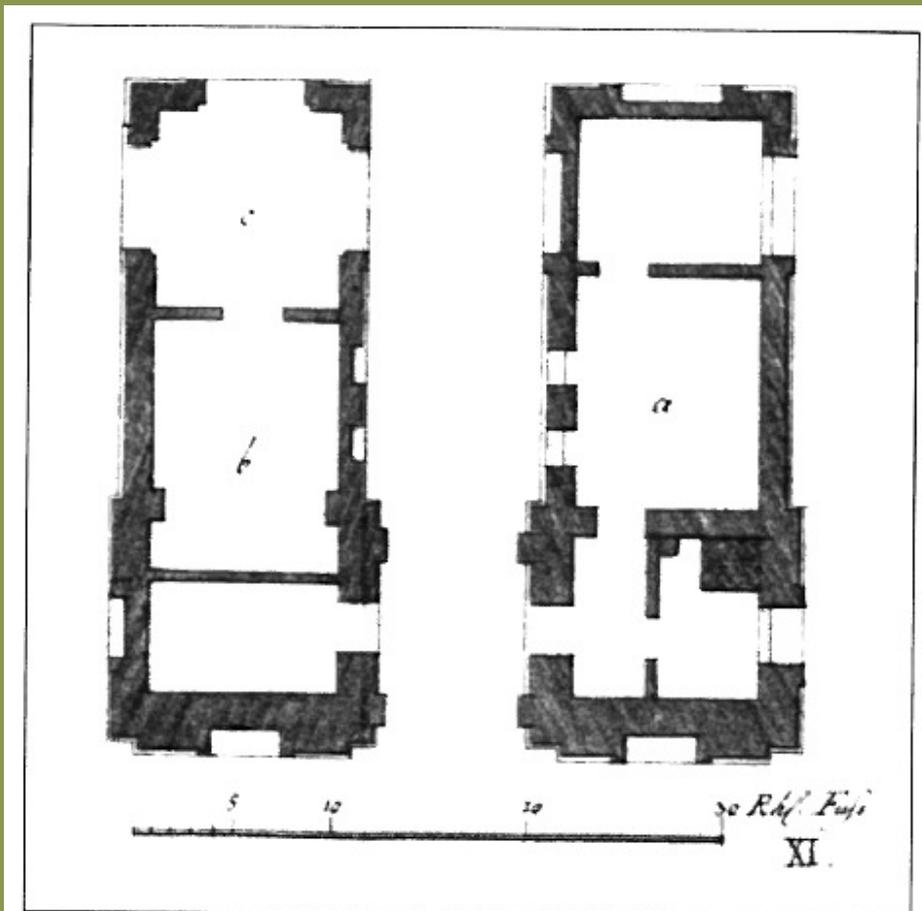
Grundriss des Eingangsgebäudes des Begräbnisplatzes.
